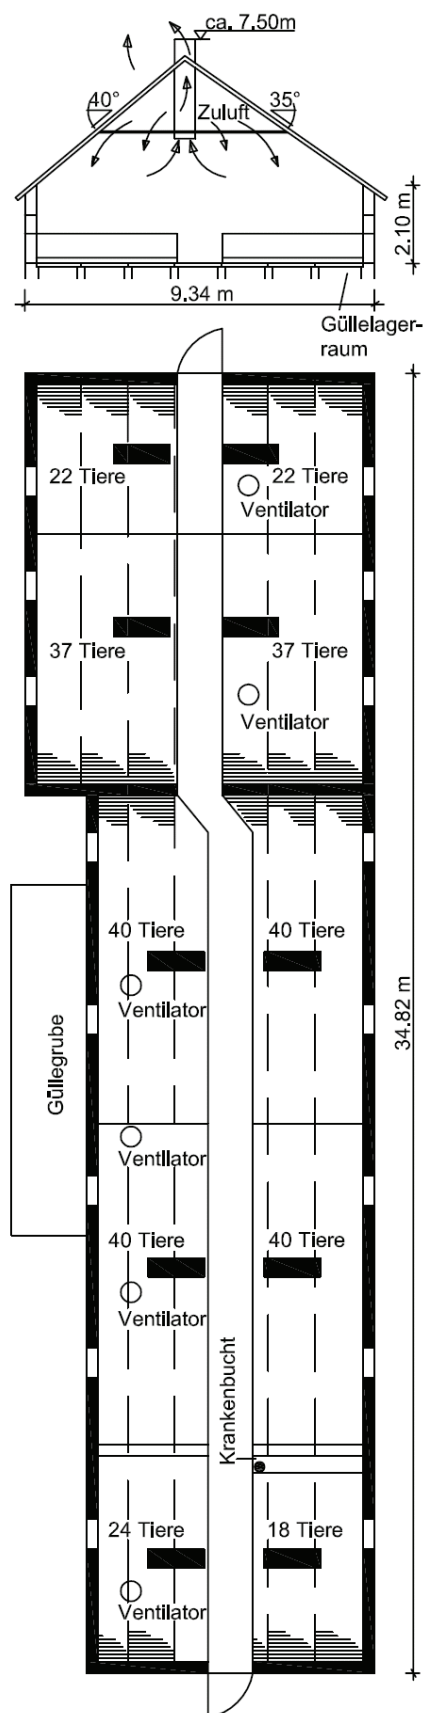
Querschnitt und Grundriss des Referenzstalles
